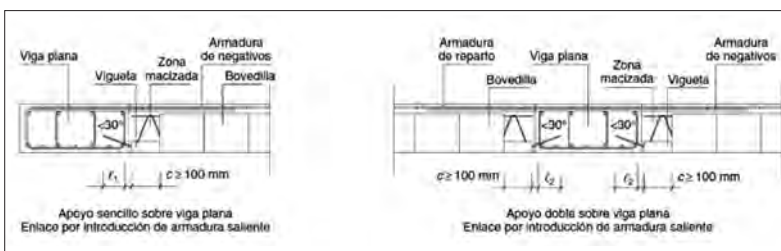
y 26: apoyo sobre viga plana. Enlace por introducción de la armadura saliente.
